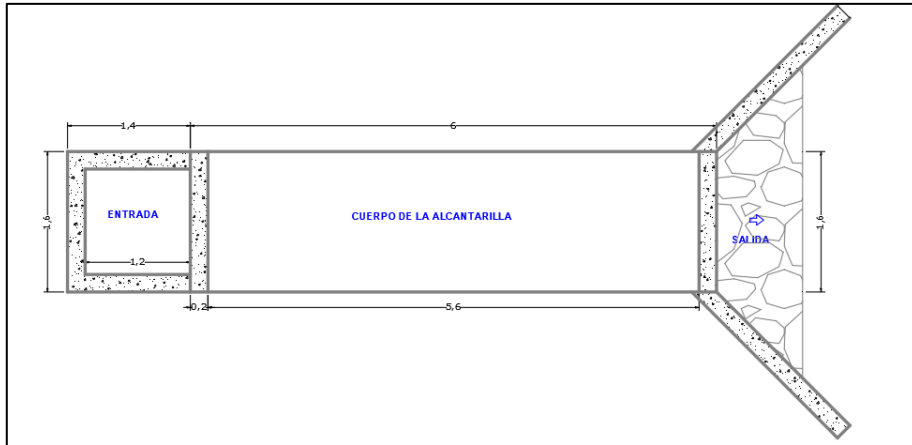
Vista en planta de la alcantarilla N°01 existente.
